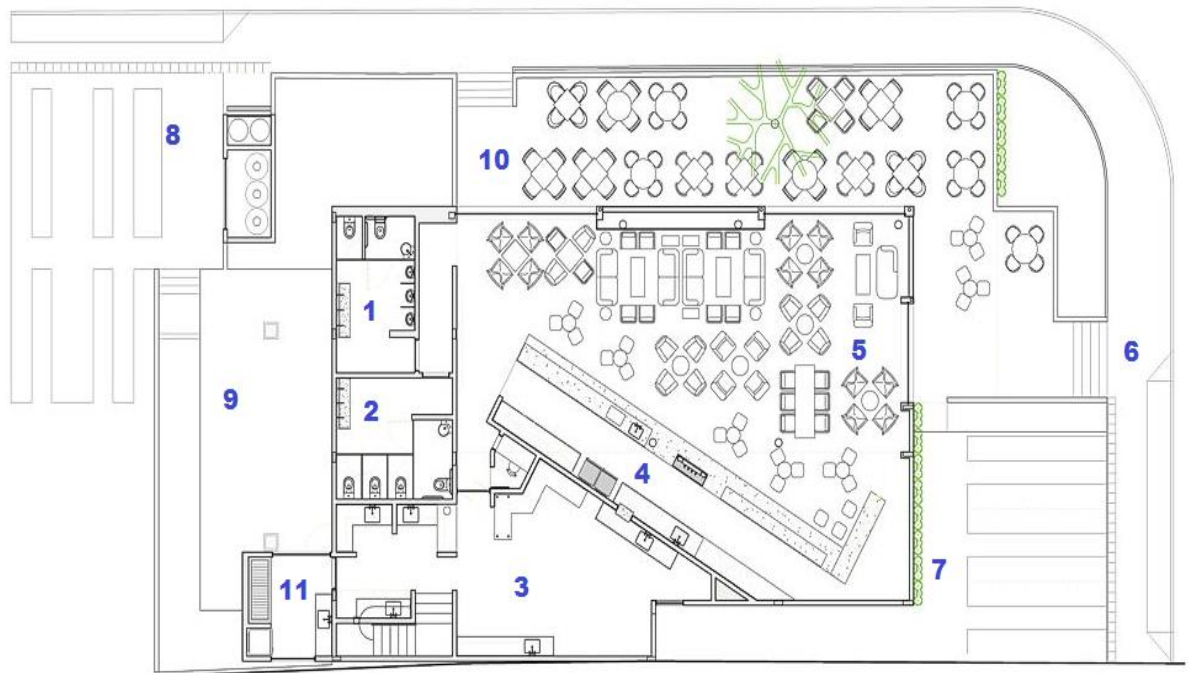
Sugestão de Planta Baixa do Empreendimento
